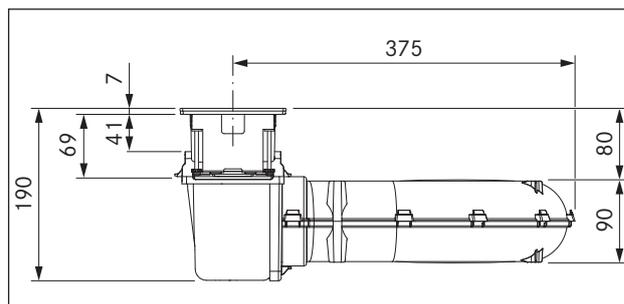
Dimensões do aparelho CKA2/CKA2AB, vista frontal
